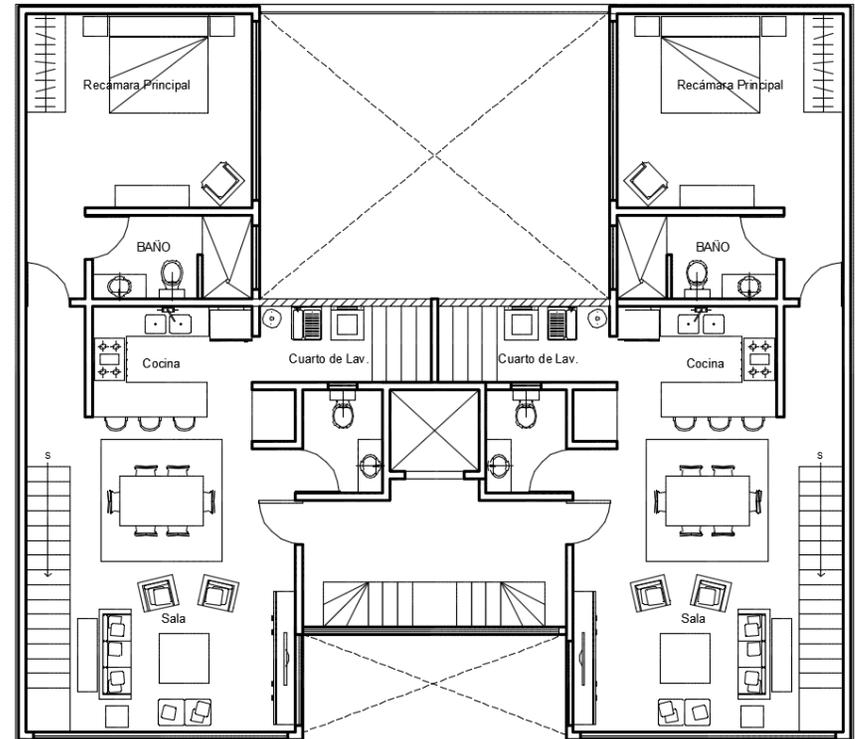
Planta tipo D Penthouse- planta baja, cuarta hipótesis
